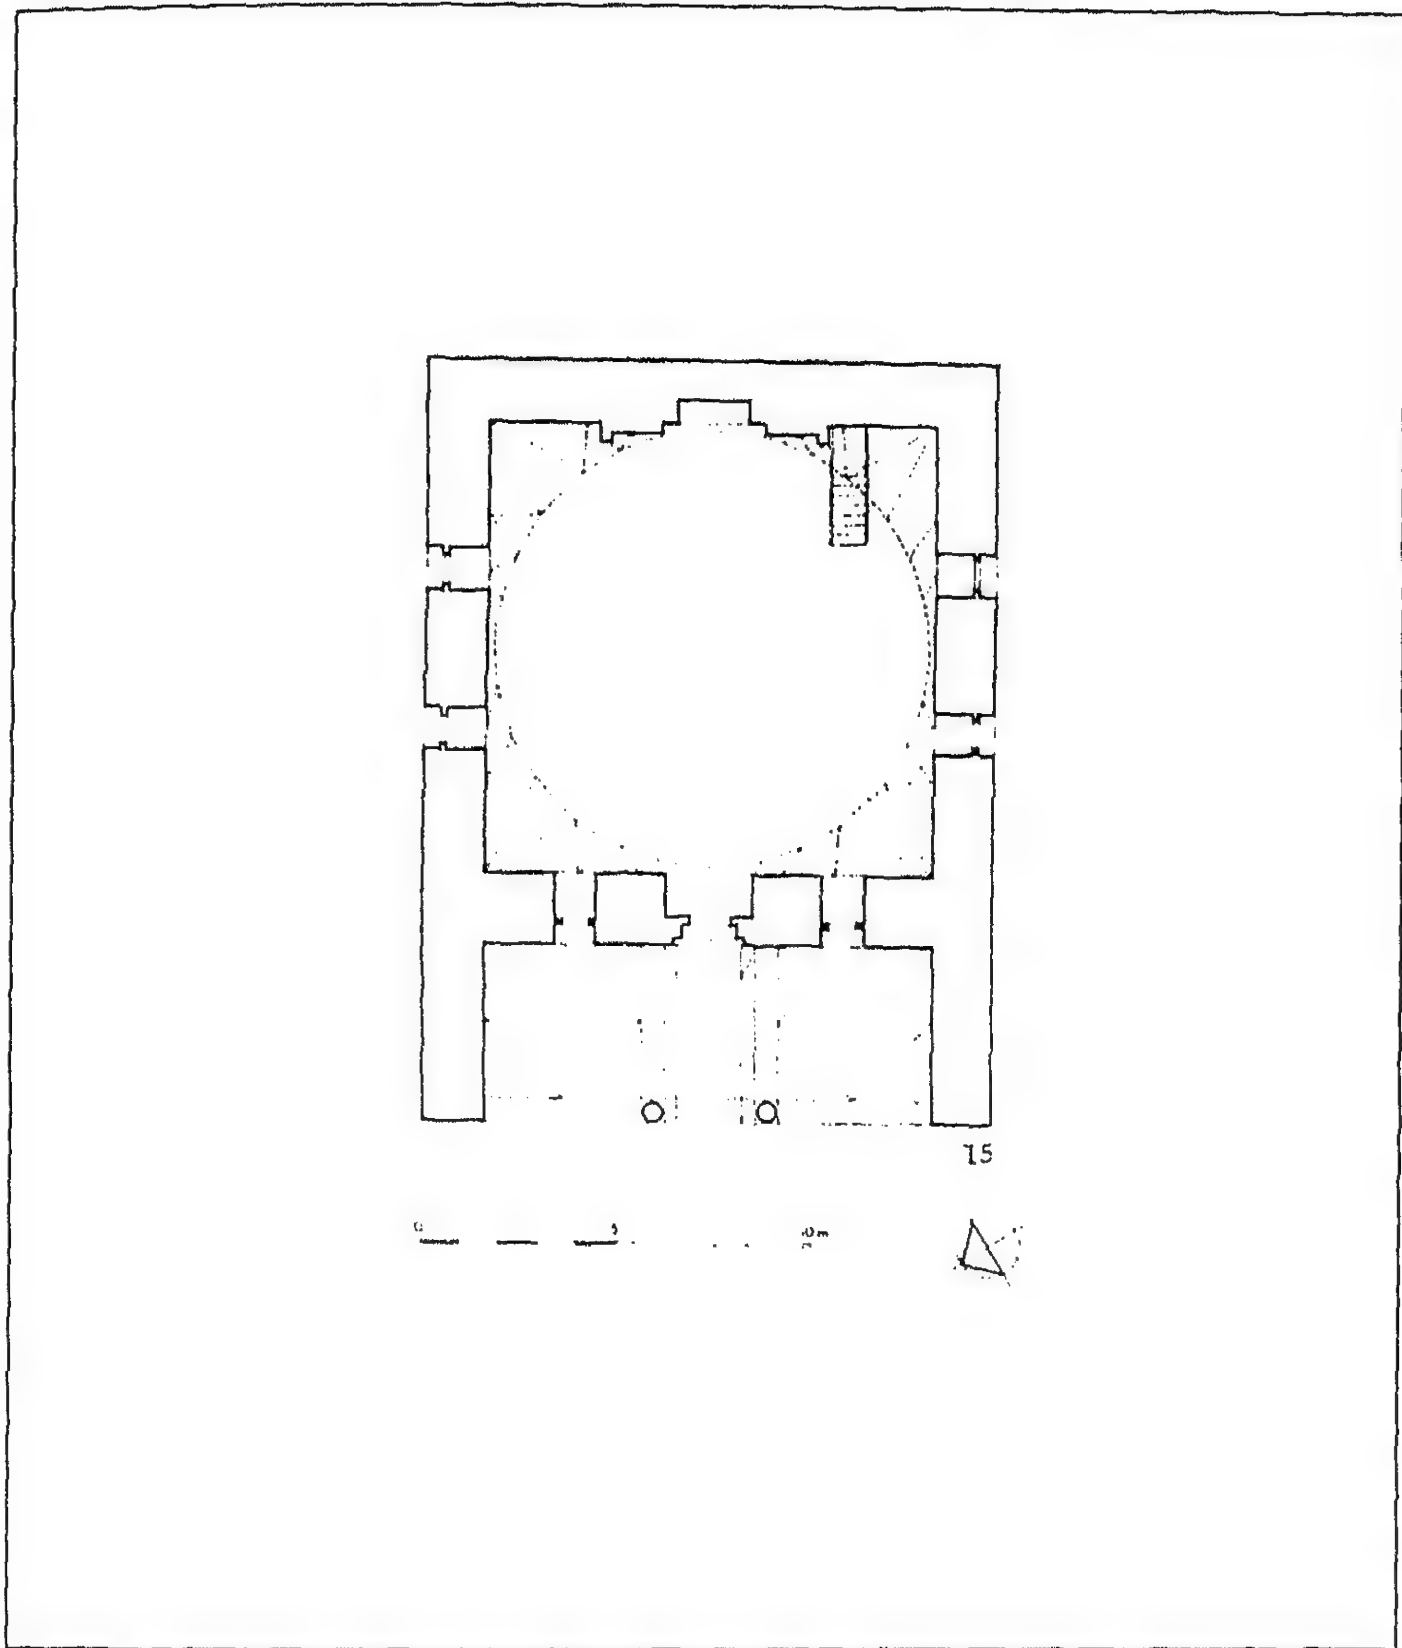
مسقط أفقي لمسجد أحمد باشا هرsek أوغلو في قيشان (عن: اصلان ابا).
